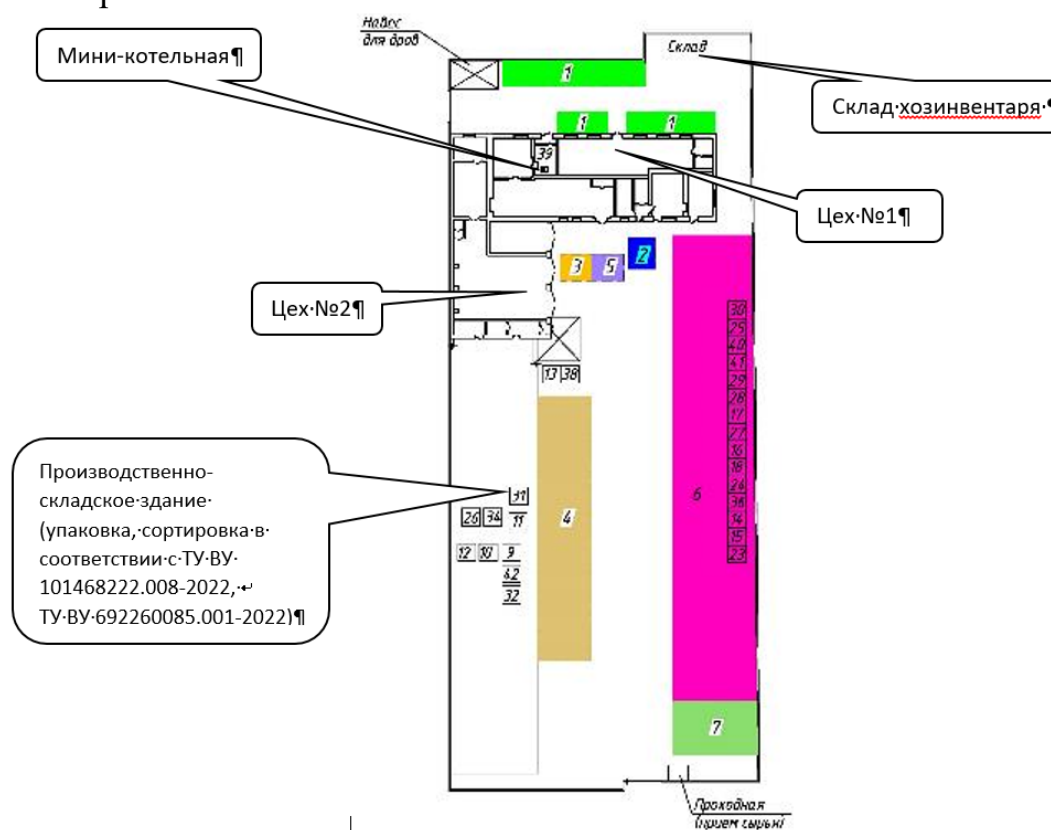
План расположения цеха №1 и №2 и площадок временного хранения
